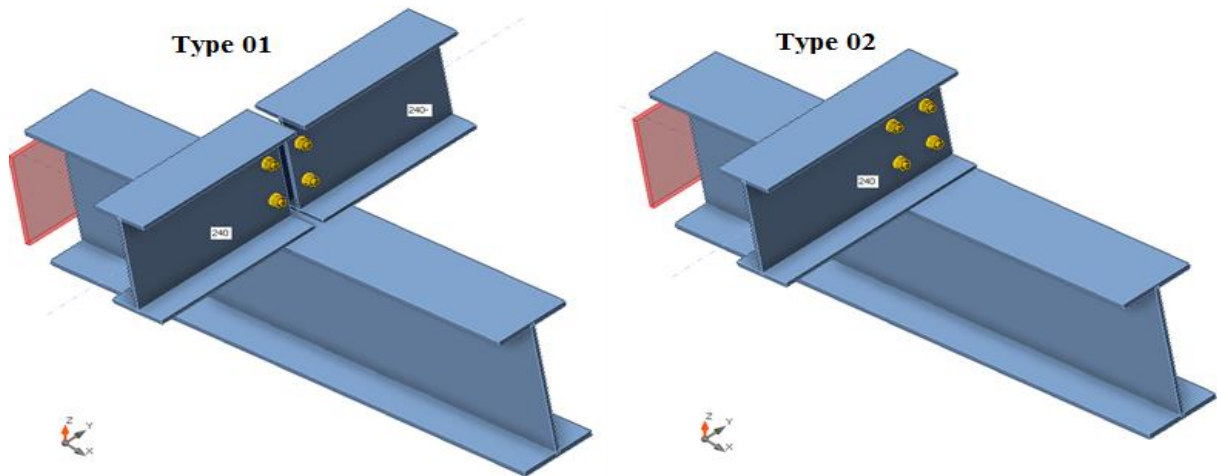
Vue 3D de l'assemblage des pannes.
